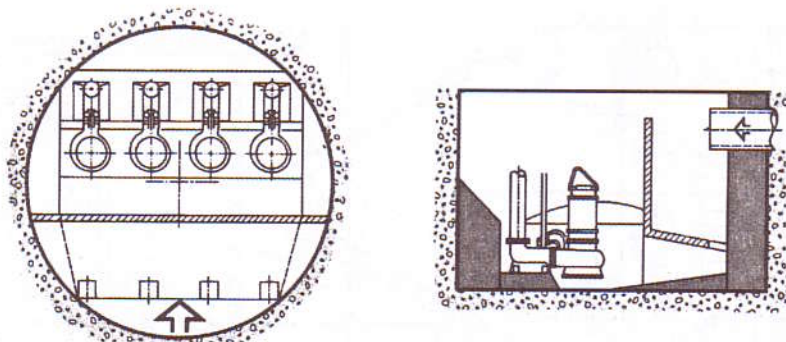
Насосно-приемный резервуар цилиндрической формы
